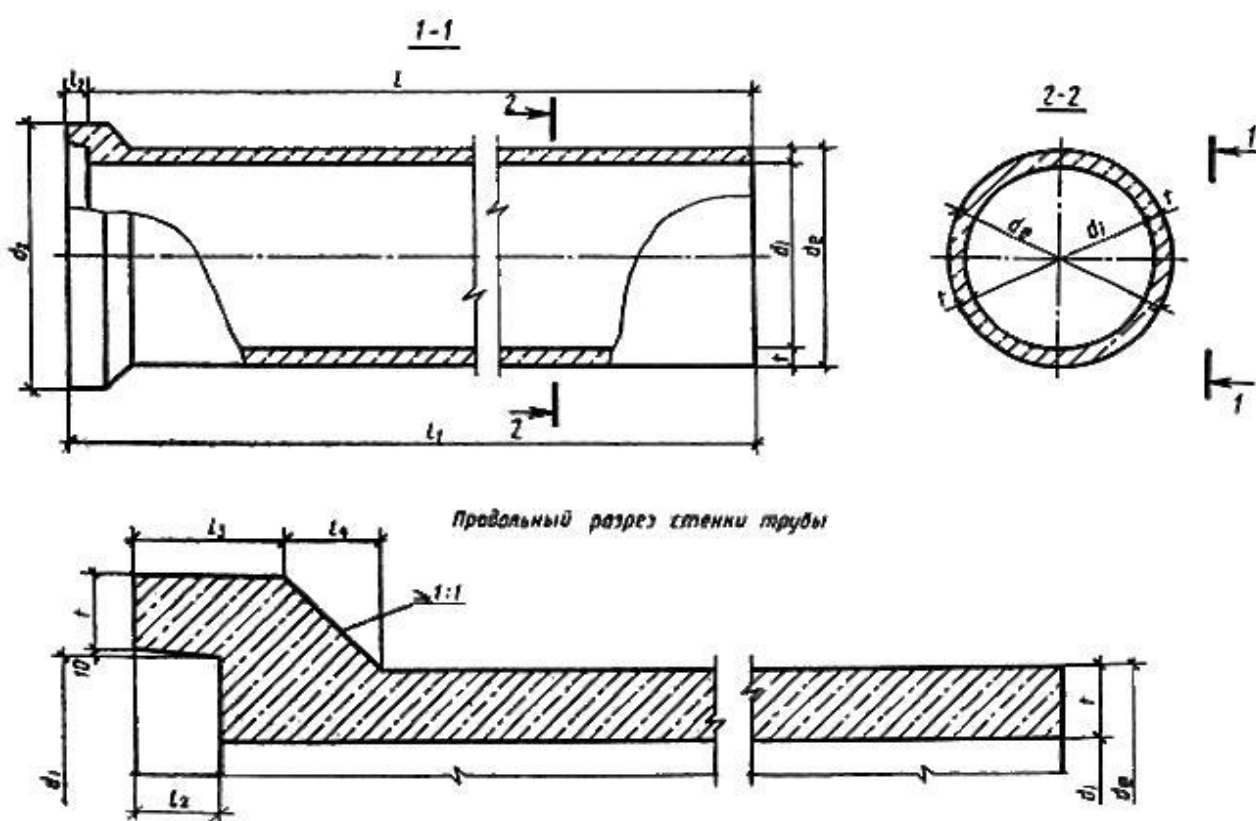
Общий вид безнапорной железобетонной трубы Т 80.50-2
